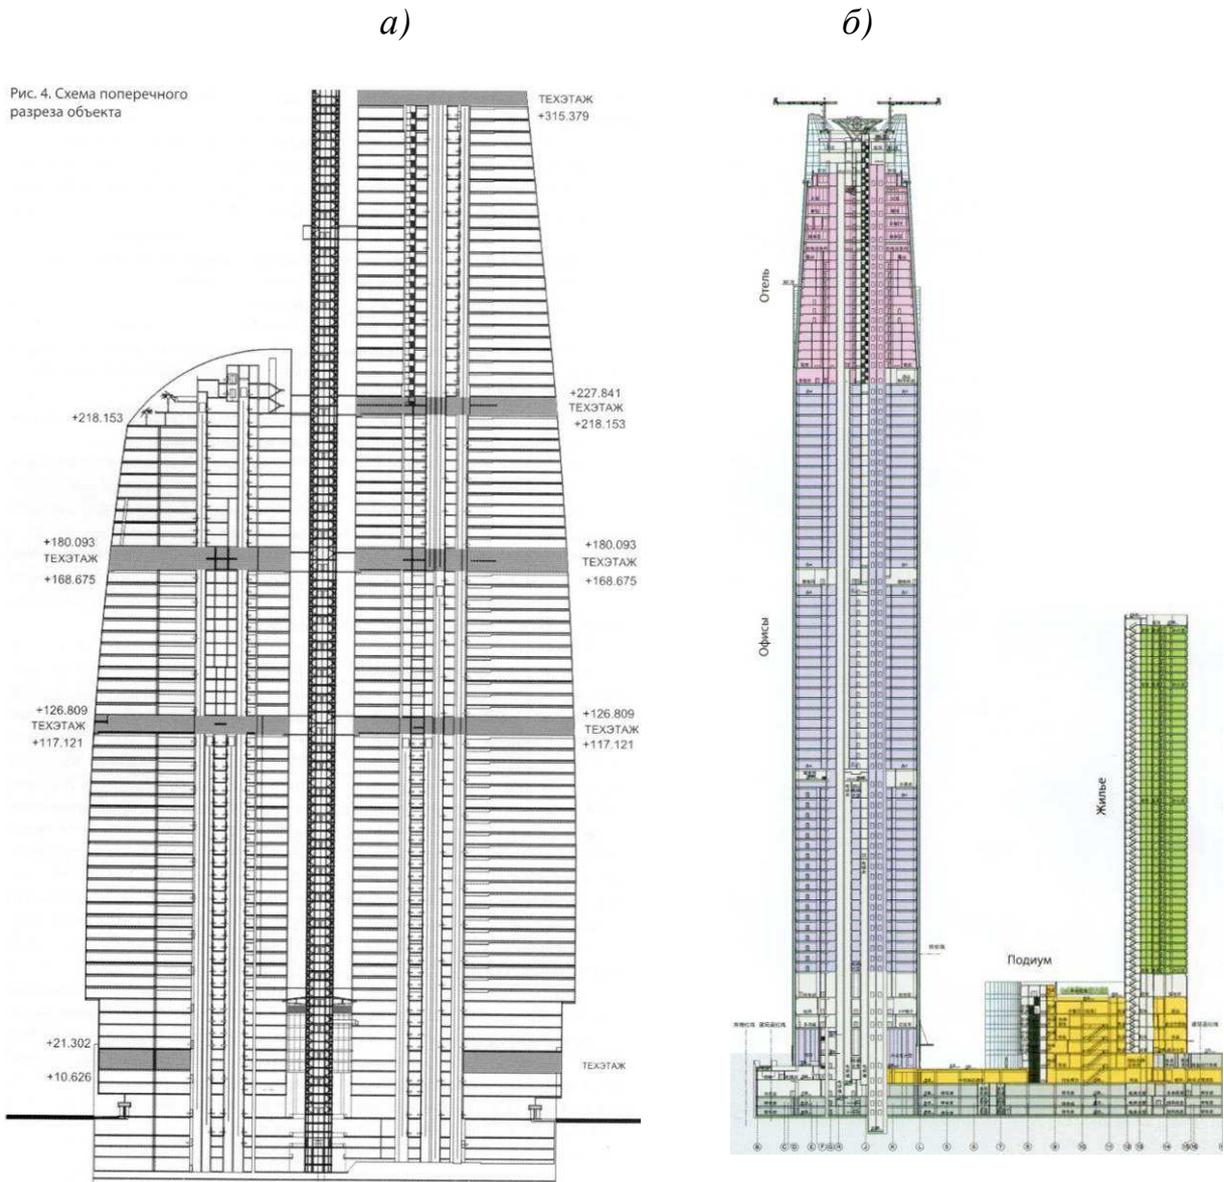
Схемы поперечных разрезов современных высотных зданий:
